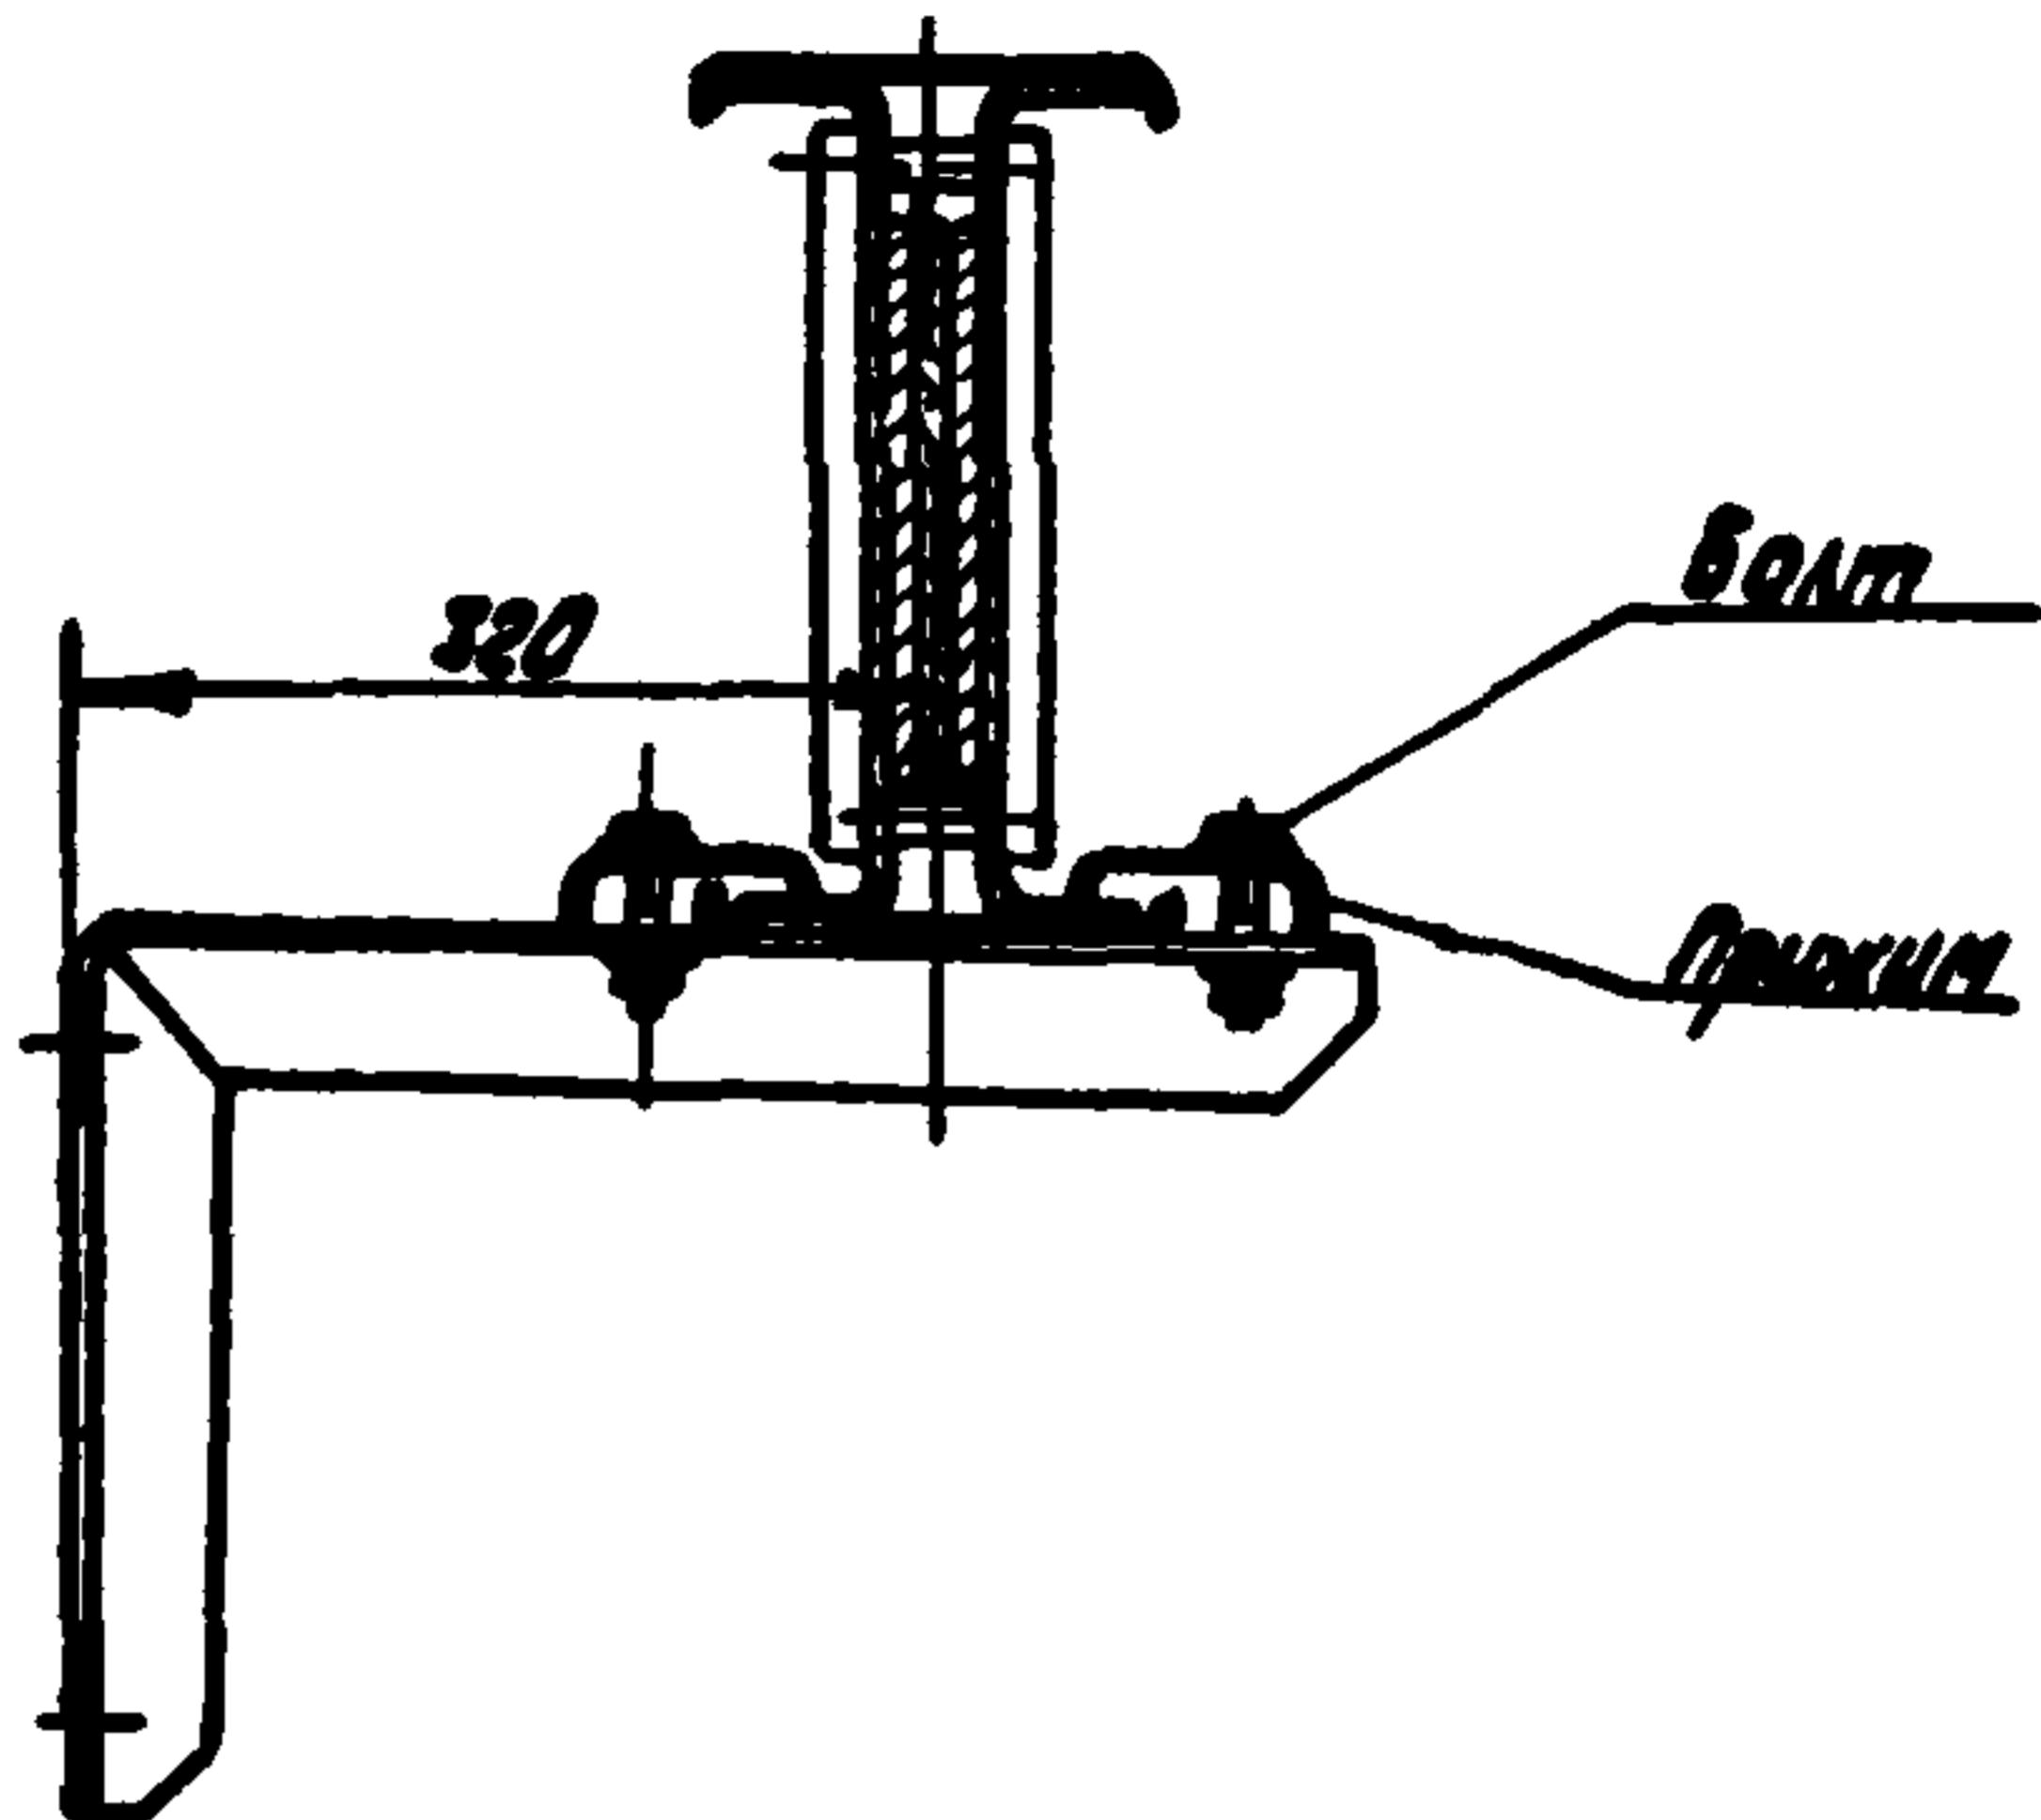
Крепление шинопровода на кронштейнах (стене, колоннах).
